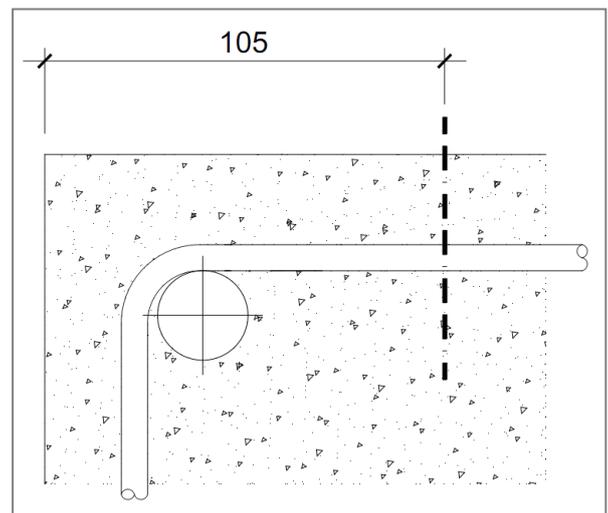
Estratto Tavola 000113_001_ESE_STR_TAV_003_rev01 Strutture elevazione
